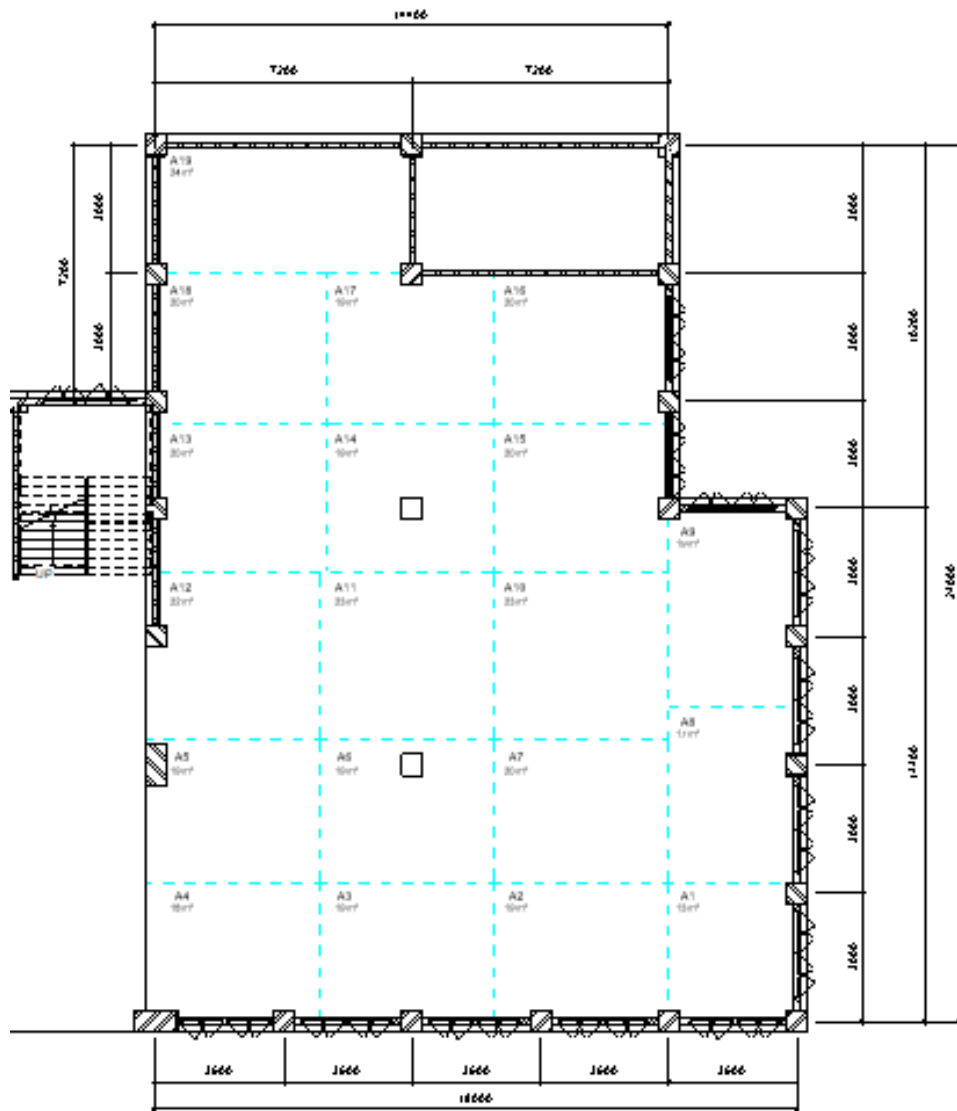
Denah Lantai 2 Perpustakaan UIN Ar-Raniry
